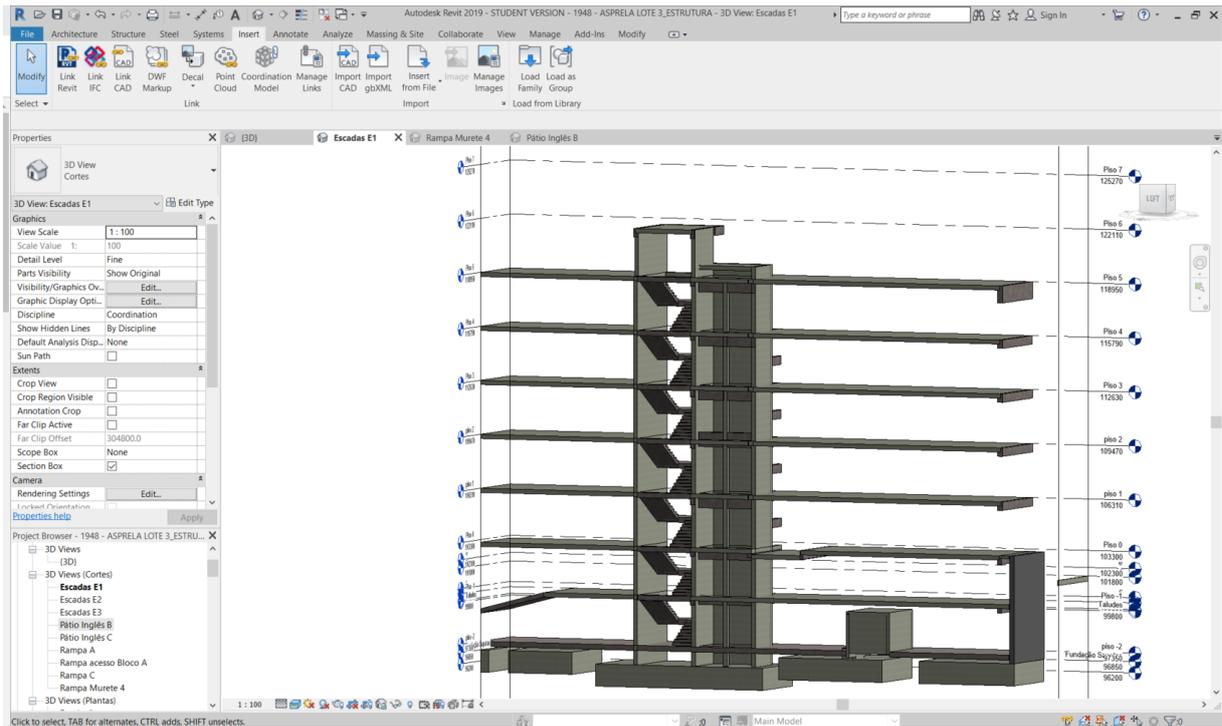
Pormenor de Execução de Escadas (autor).
